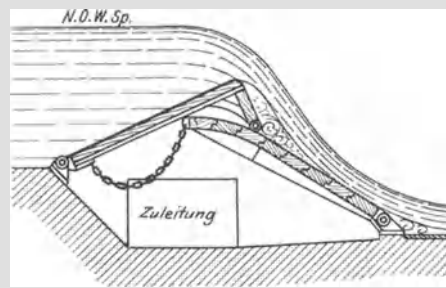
Doppelklappe am Chicago-Drainage-Kanal. Maßstab 1 : 380.
